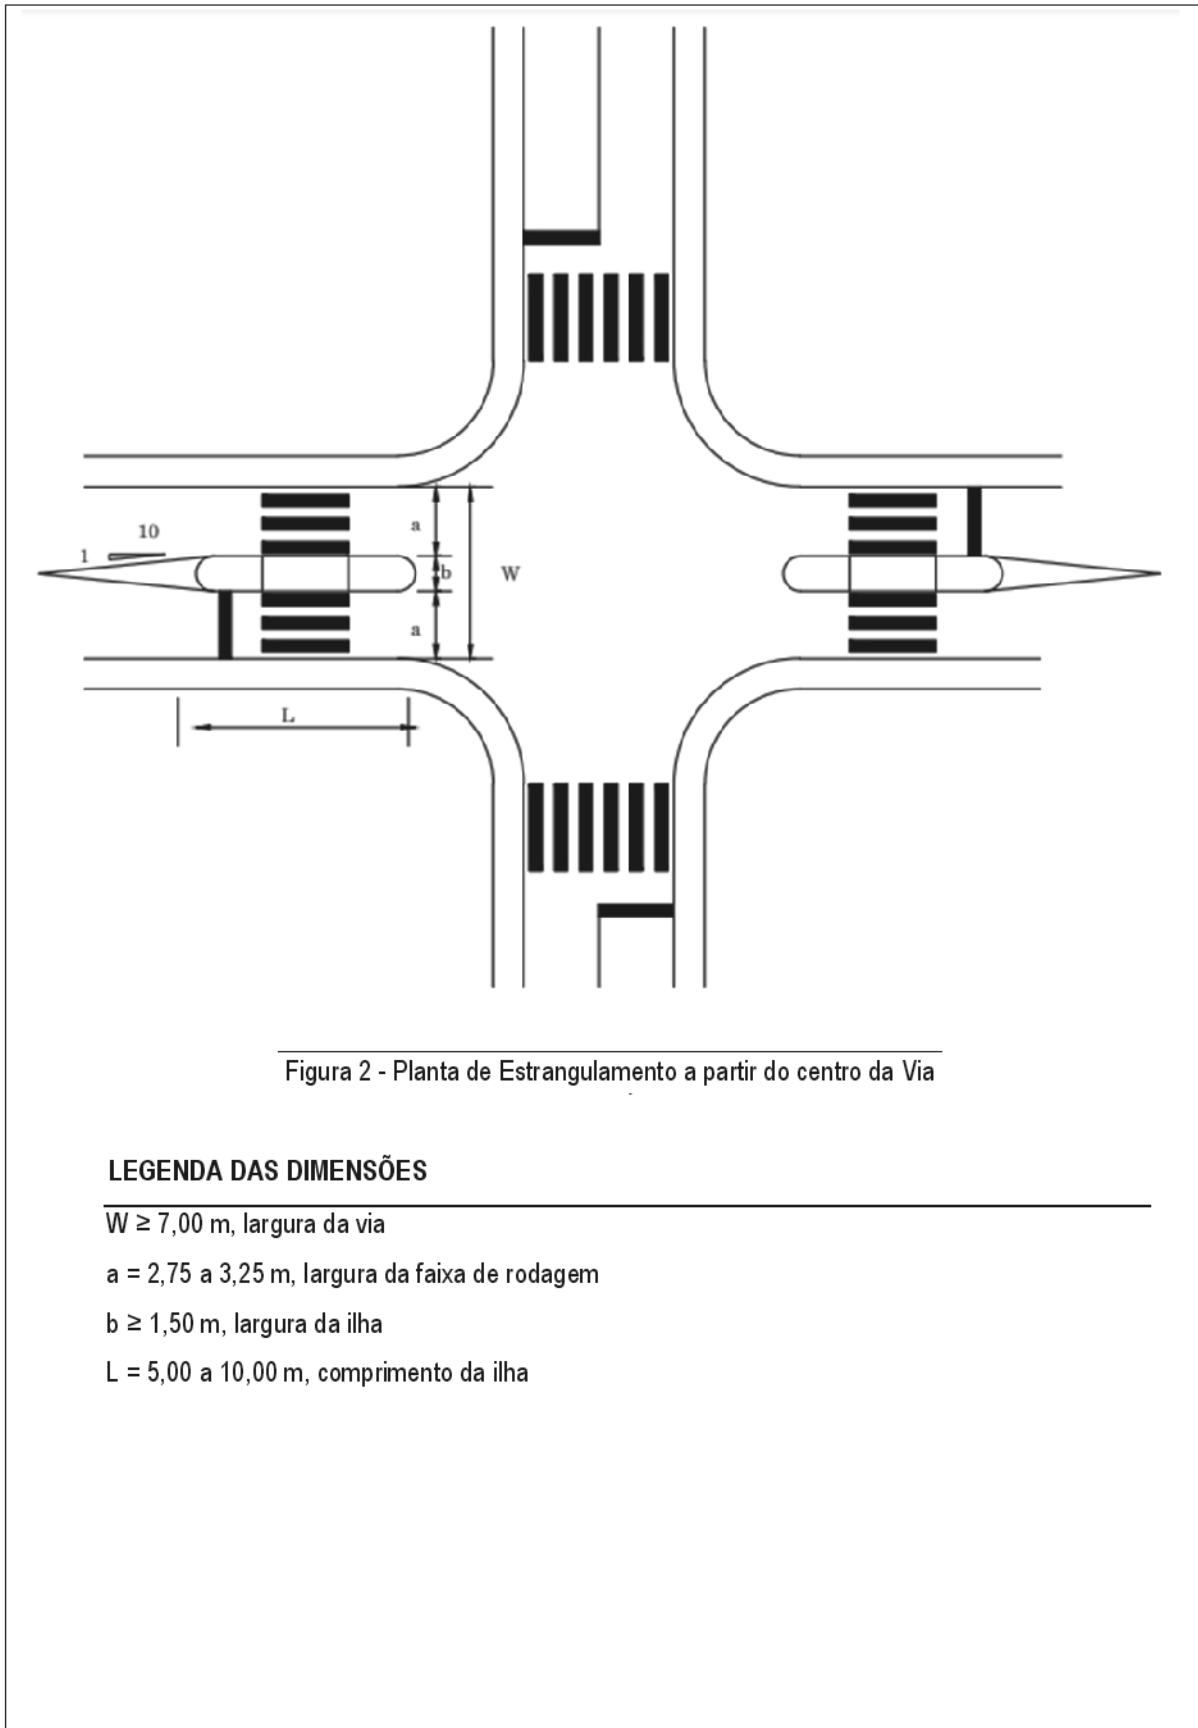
Planta de Estrangulamento a partir do centro da Via
